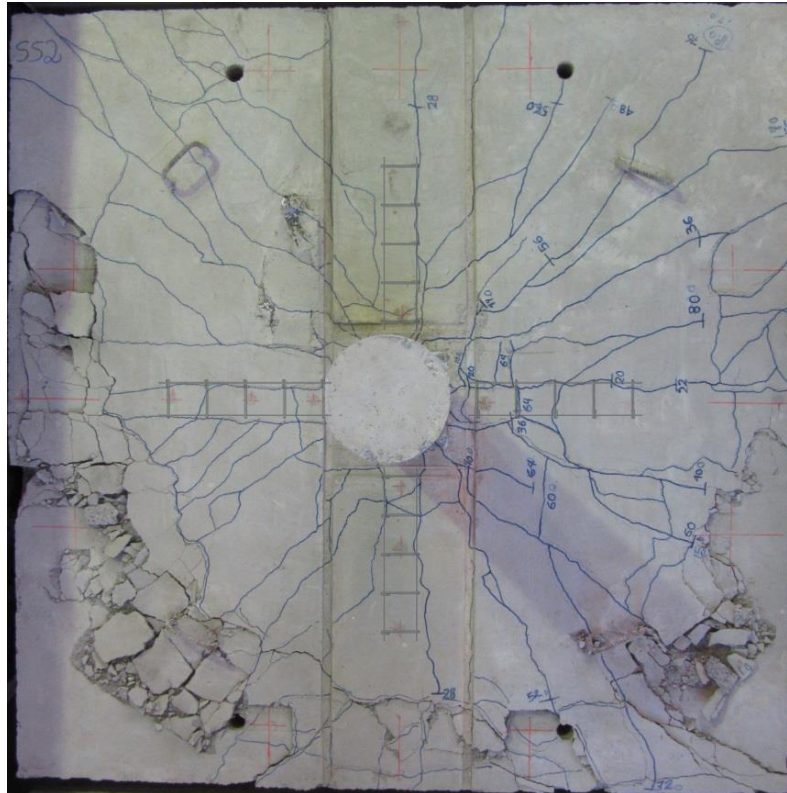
Mapa de fissuração da laje SS2
